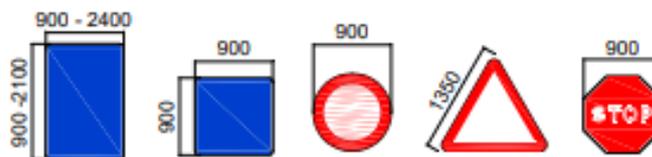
Dimensiones para señales de contenido fijo para carreteras con arcén (Fuente: Norma 8.1-IC)
